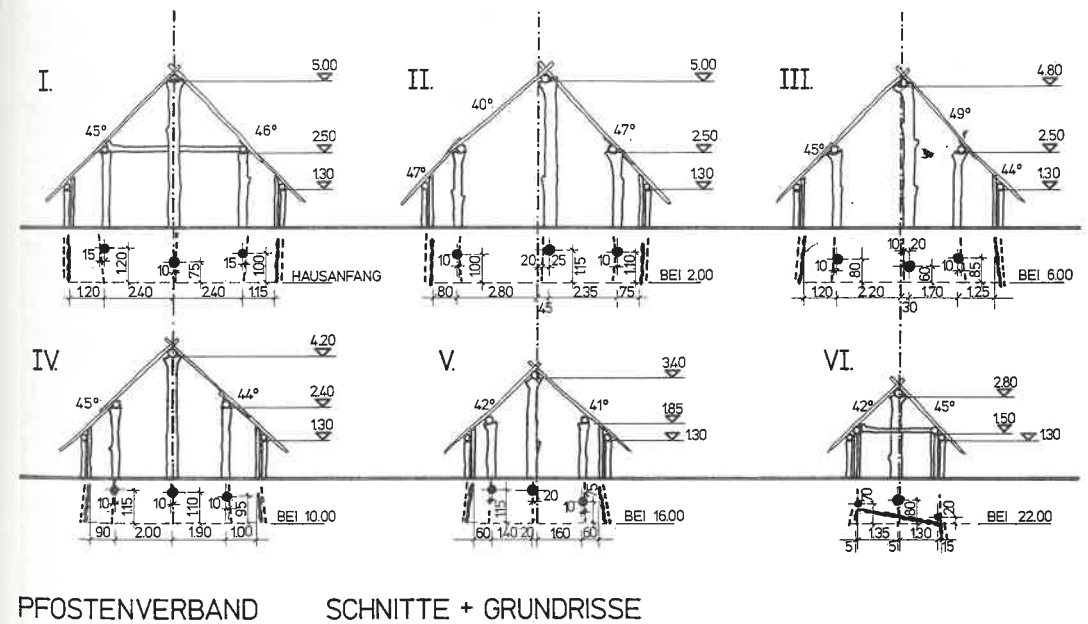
Rekonstruktionszeichnung: Inden 1, Bau-Nr. 9, Pfostenverband, Schnitte und Grundrisse.
